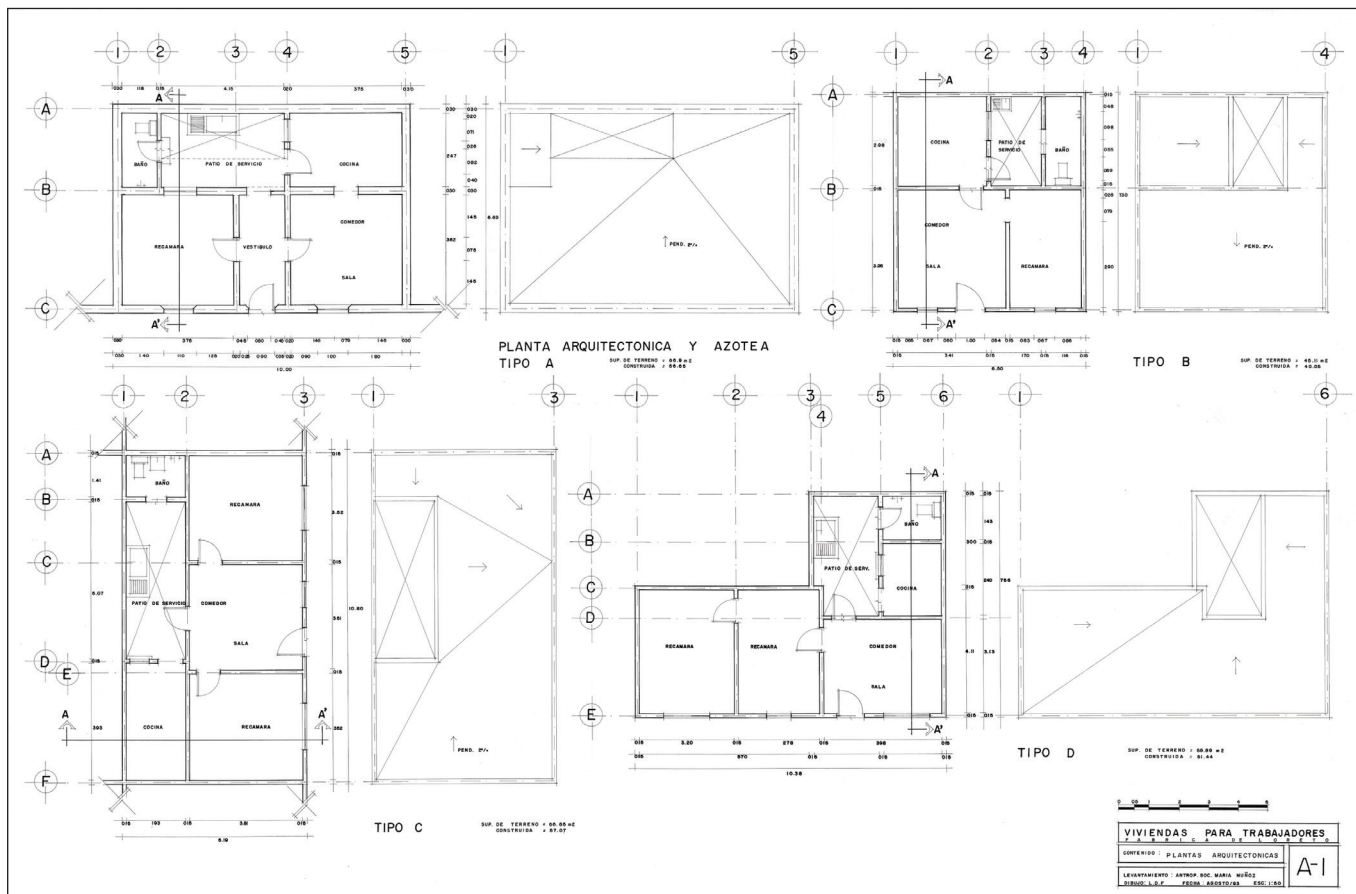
Plantas arquitectónicas de tipos de vivienda para trabajadores de Loreto (Dibujo: Laura Díaz Flores 1993).
